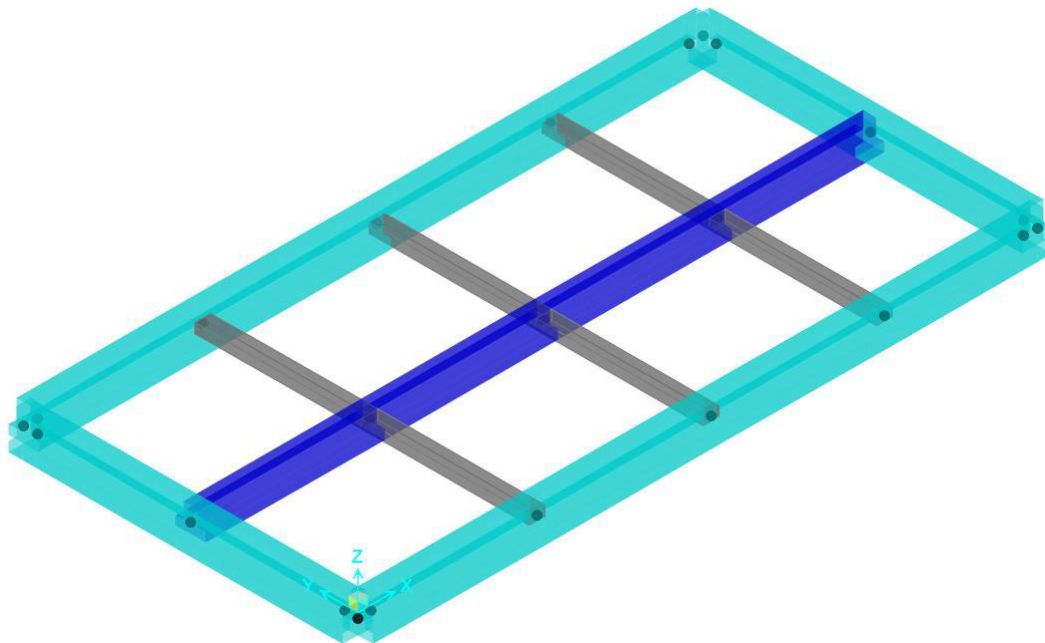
Vista assometrica modello della struttura di fondazione
